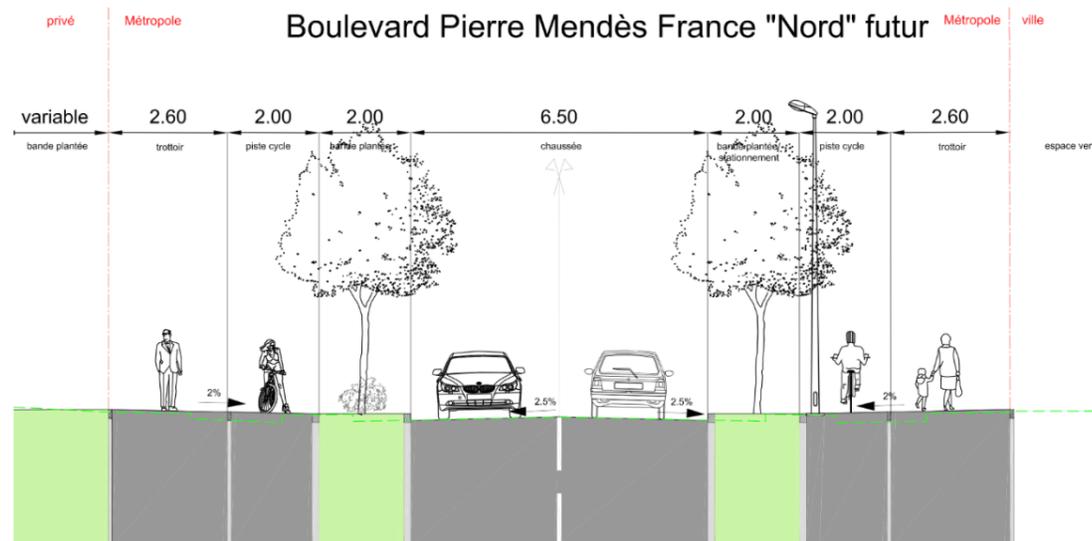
Projet – Boulevard Pierre Mendès France – section nord – coupe C
